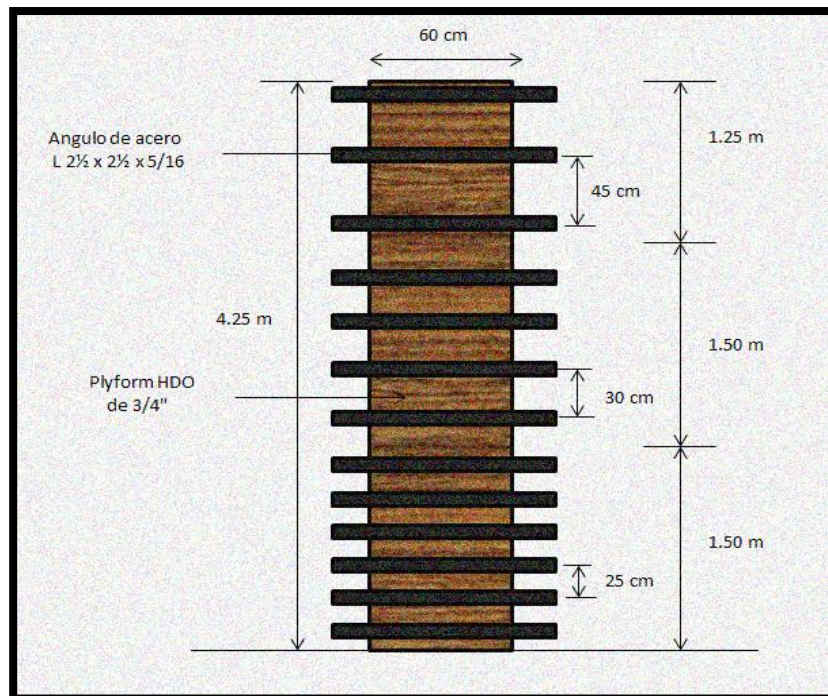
Diseño de encofrado mixto para columnas. (Elaboración propia).
